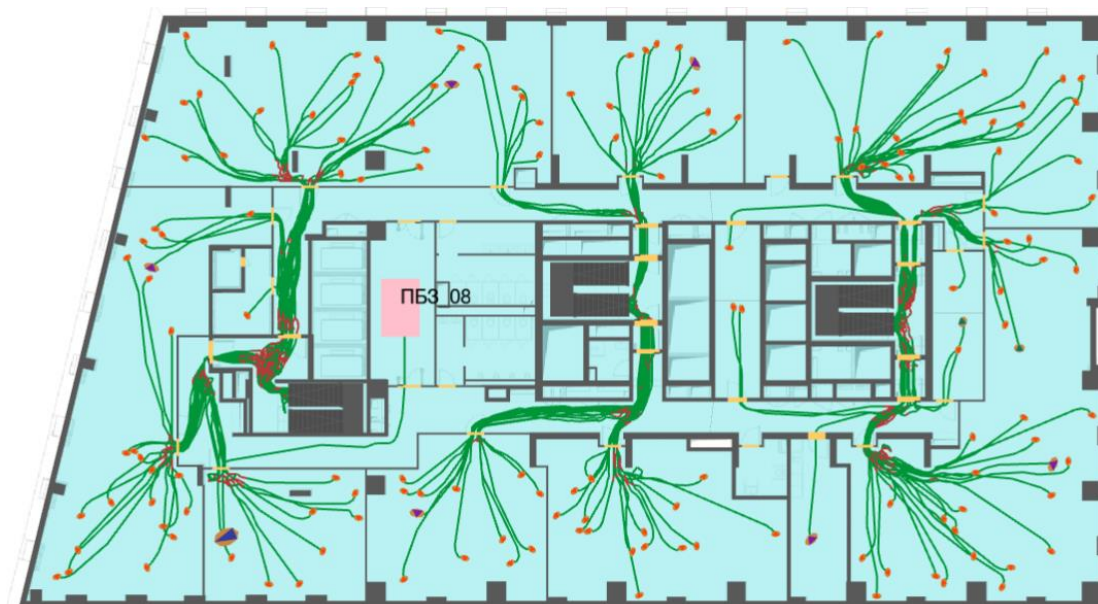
План 8-го этажа и нанесенная на него расчетная (принципиальная) схема эвакуации
